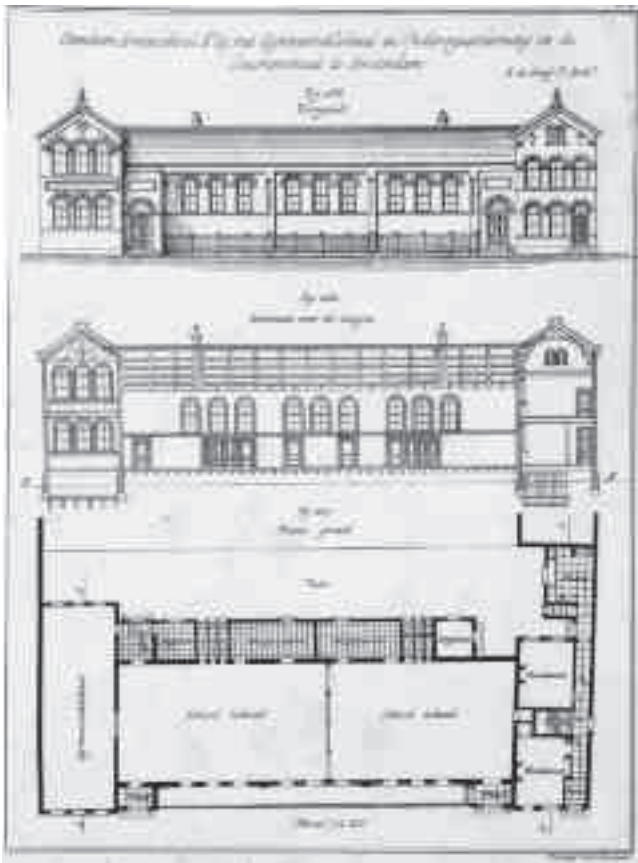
Openbare Armeschool voor 360 kinderen aan de Schiemanstraat, zijgevel en plattegrond, 1862 (Stadsarchief Amsterdam, schetsboek Willem Springer)
